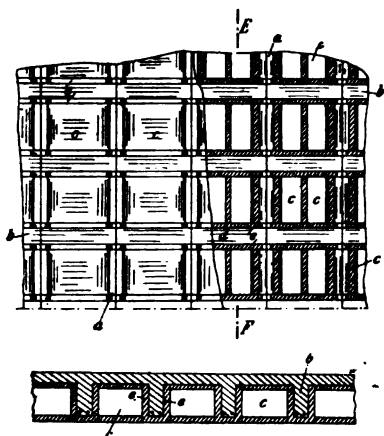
Eichberg-Decke im Grundriß und Querschnitt.
